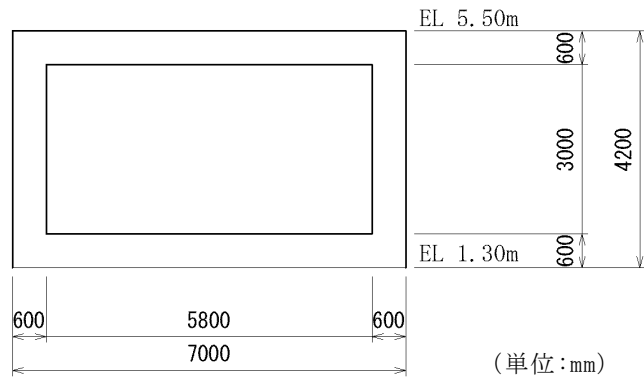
(1) 屋外配管ダクト (タービン建物～放水槽) 断面図 (A-A 断面)
